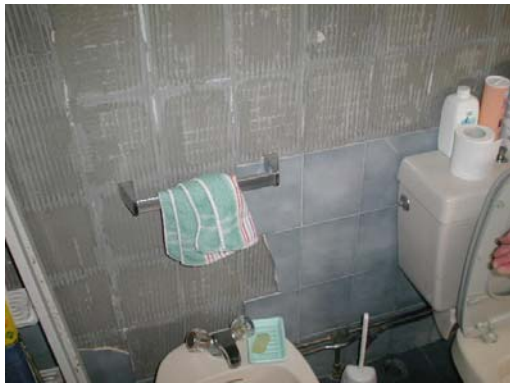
Paredes – Azulejos/Descolamentos, AI-4.
